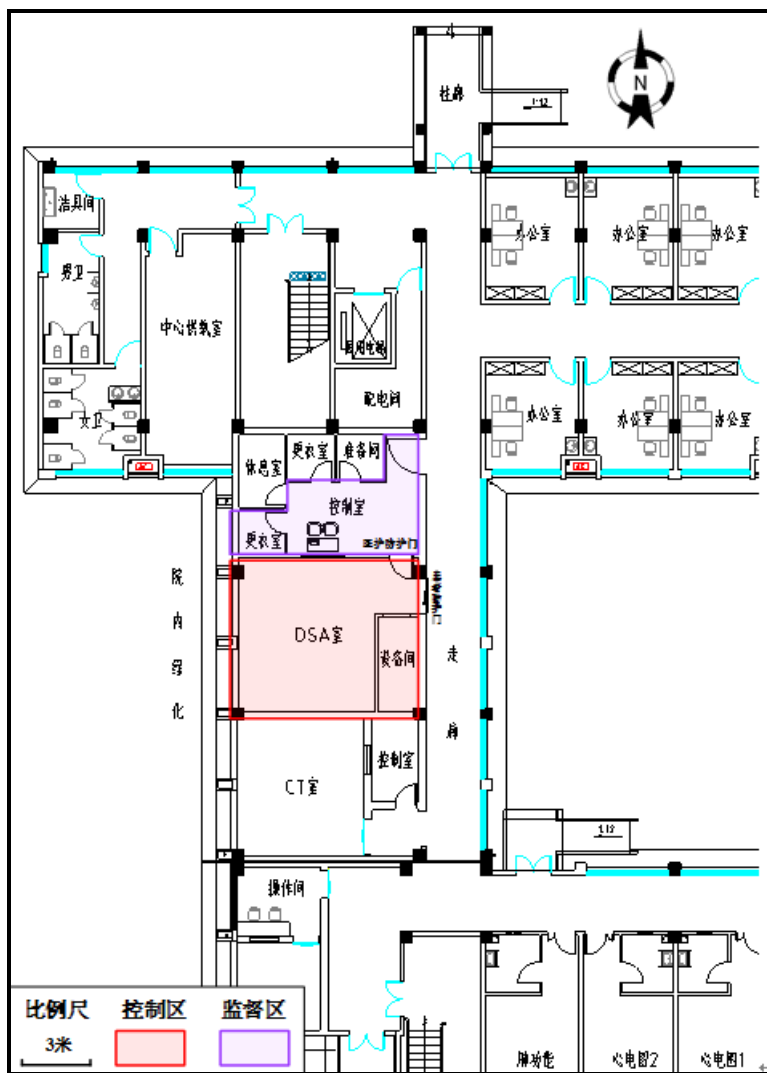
3 号楼一层 DSA 室平面布置及分区示意图
